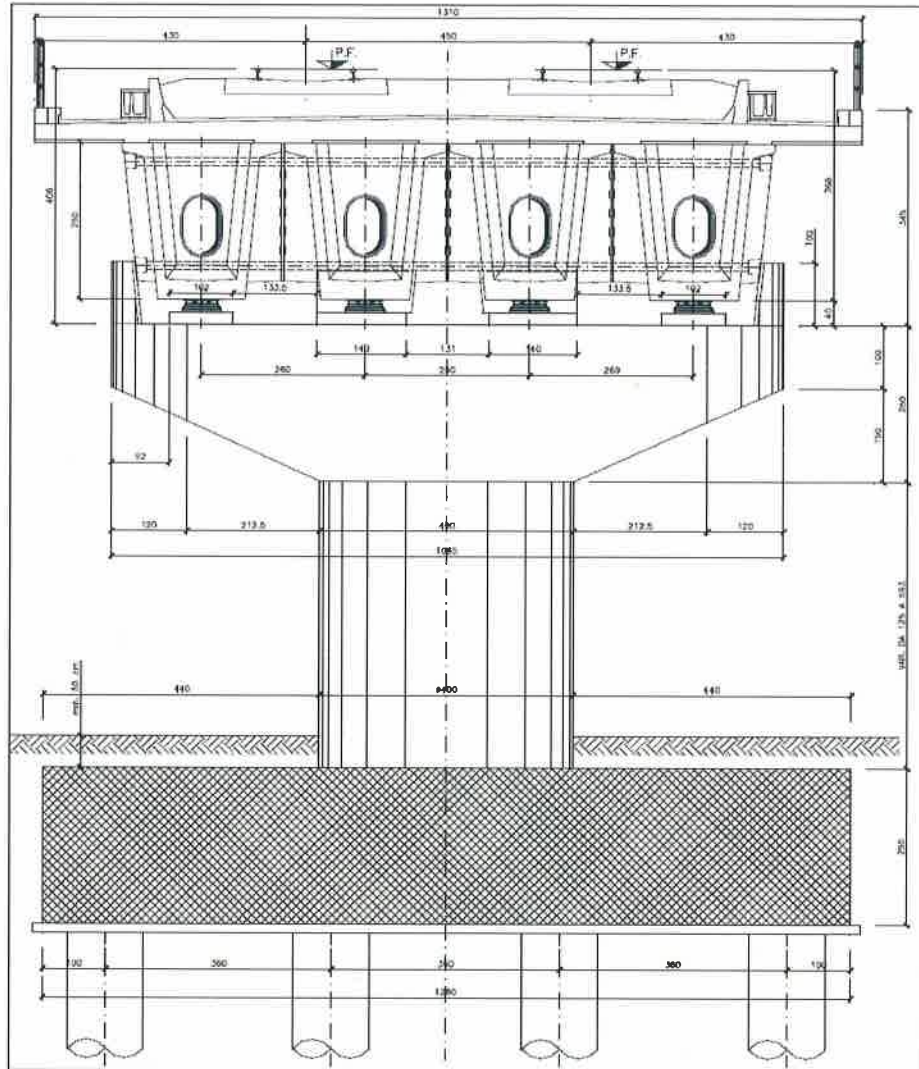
sezione tipo pila dei viadotti in progetto
